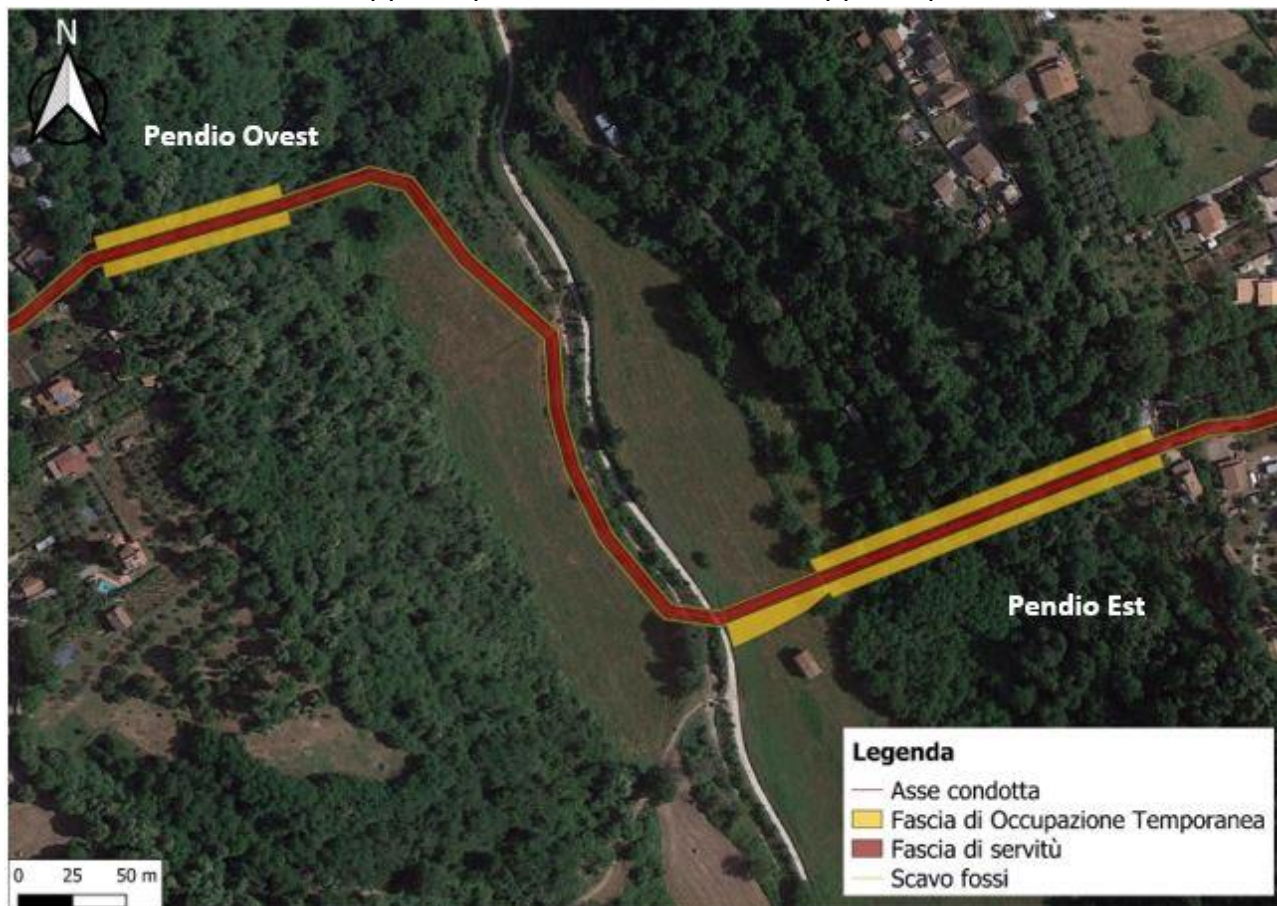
Planimetria attività di lavoro su Fosso di Cave
